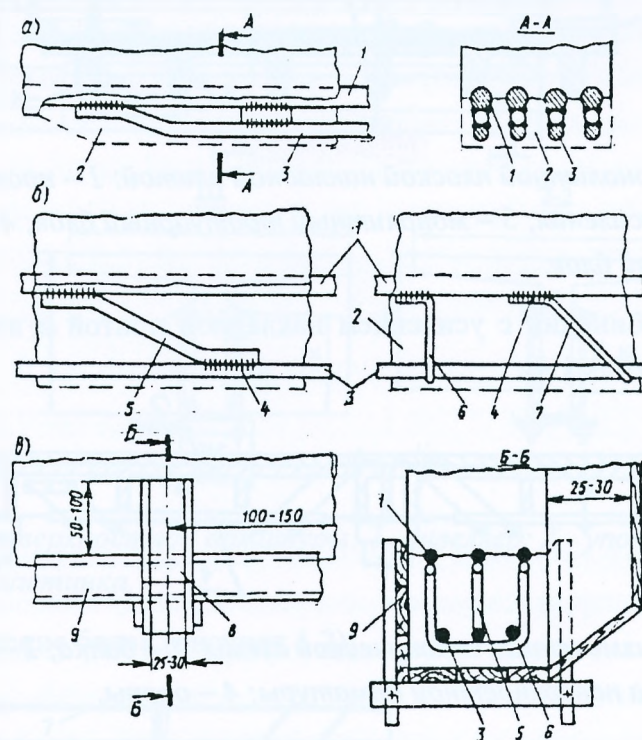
Усиление железобетонных балок добавочной арматурой: 1 – существующая арматура; 2 – зона усиления; 3 – арматура усиления; 4 – сварки; 5 – наклонный коротыш; 6 – прямой хомут; 7 – наклонный хомут; 8 – загрузочные воронки; 9 – опалубка.
